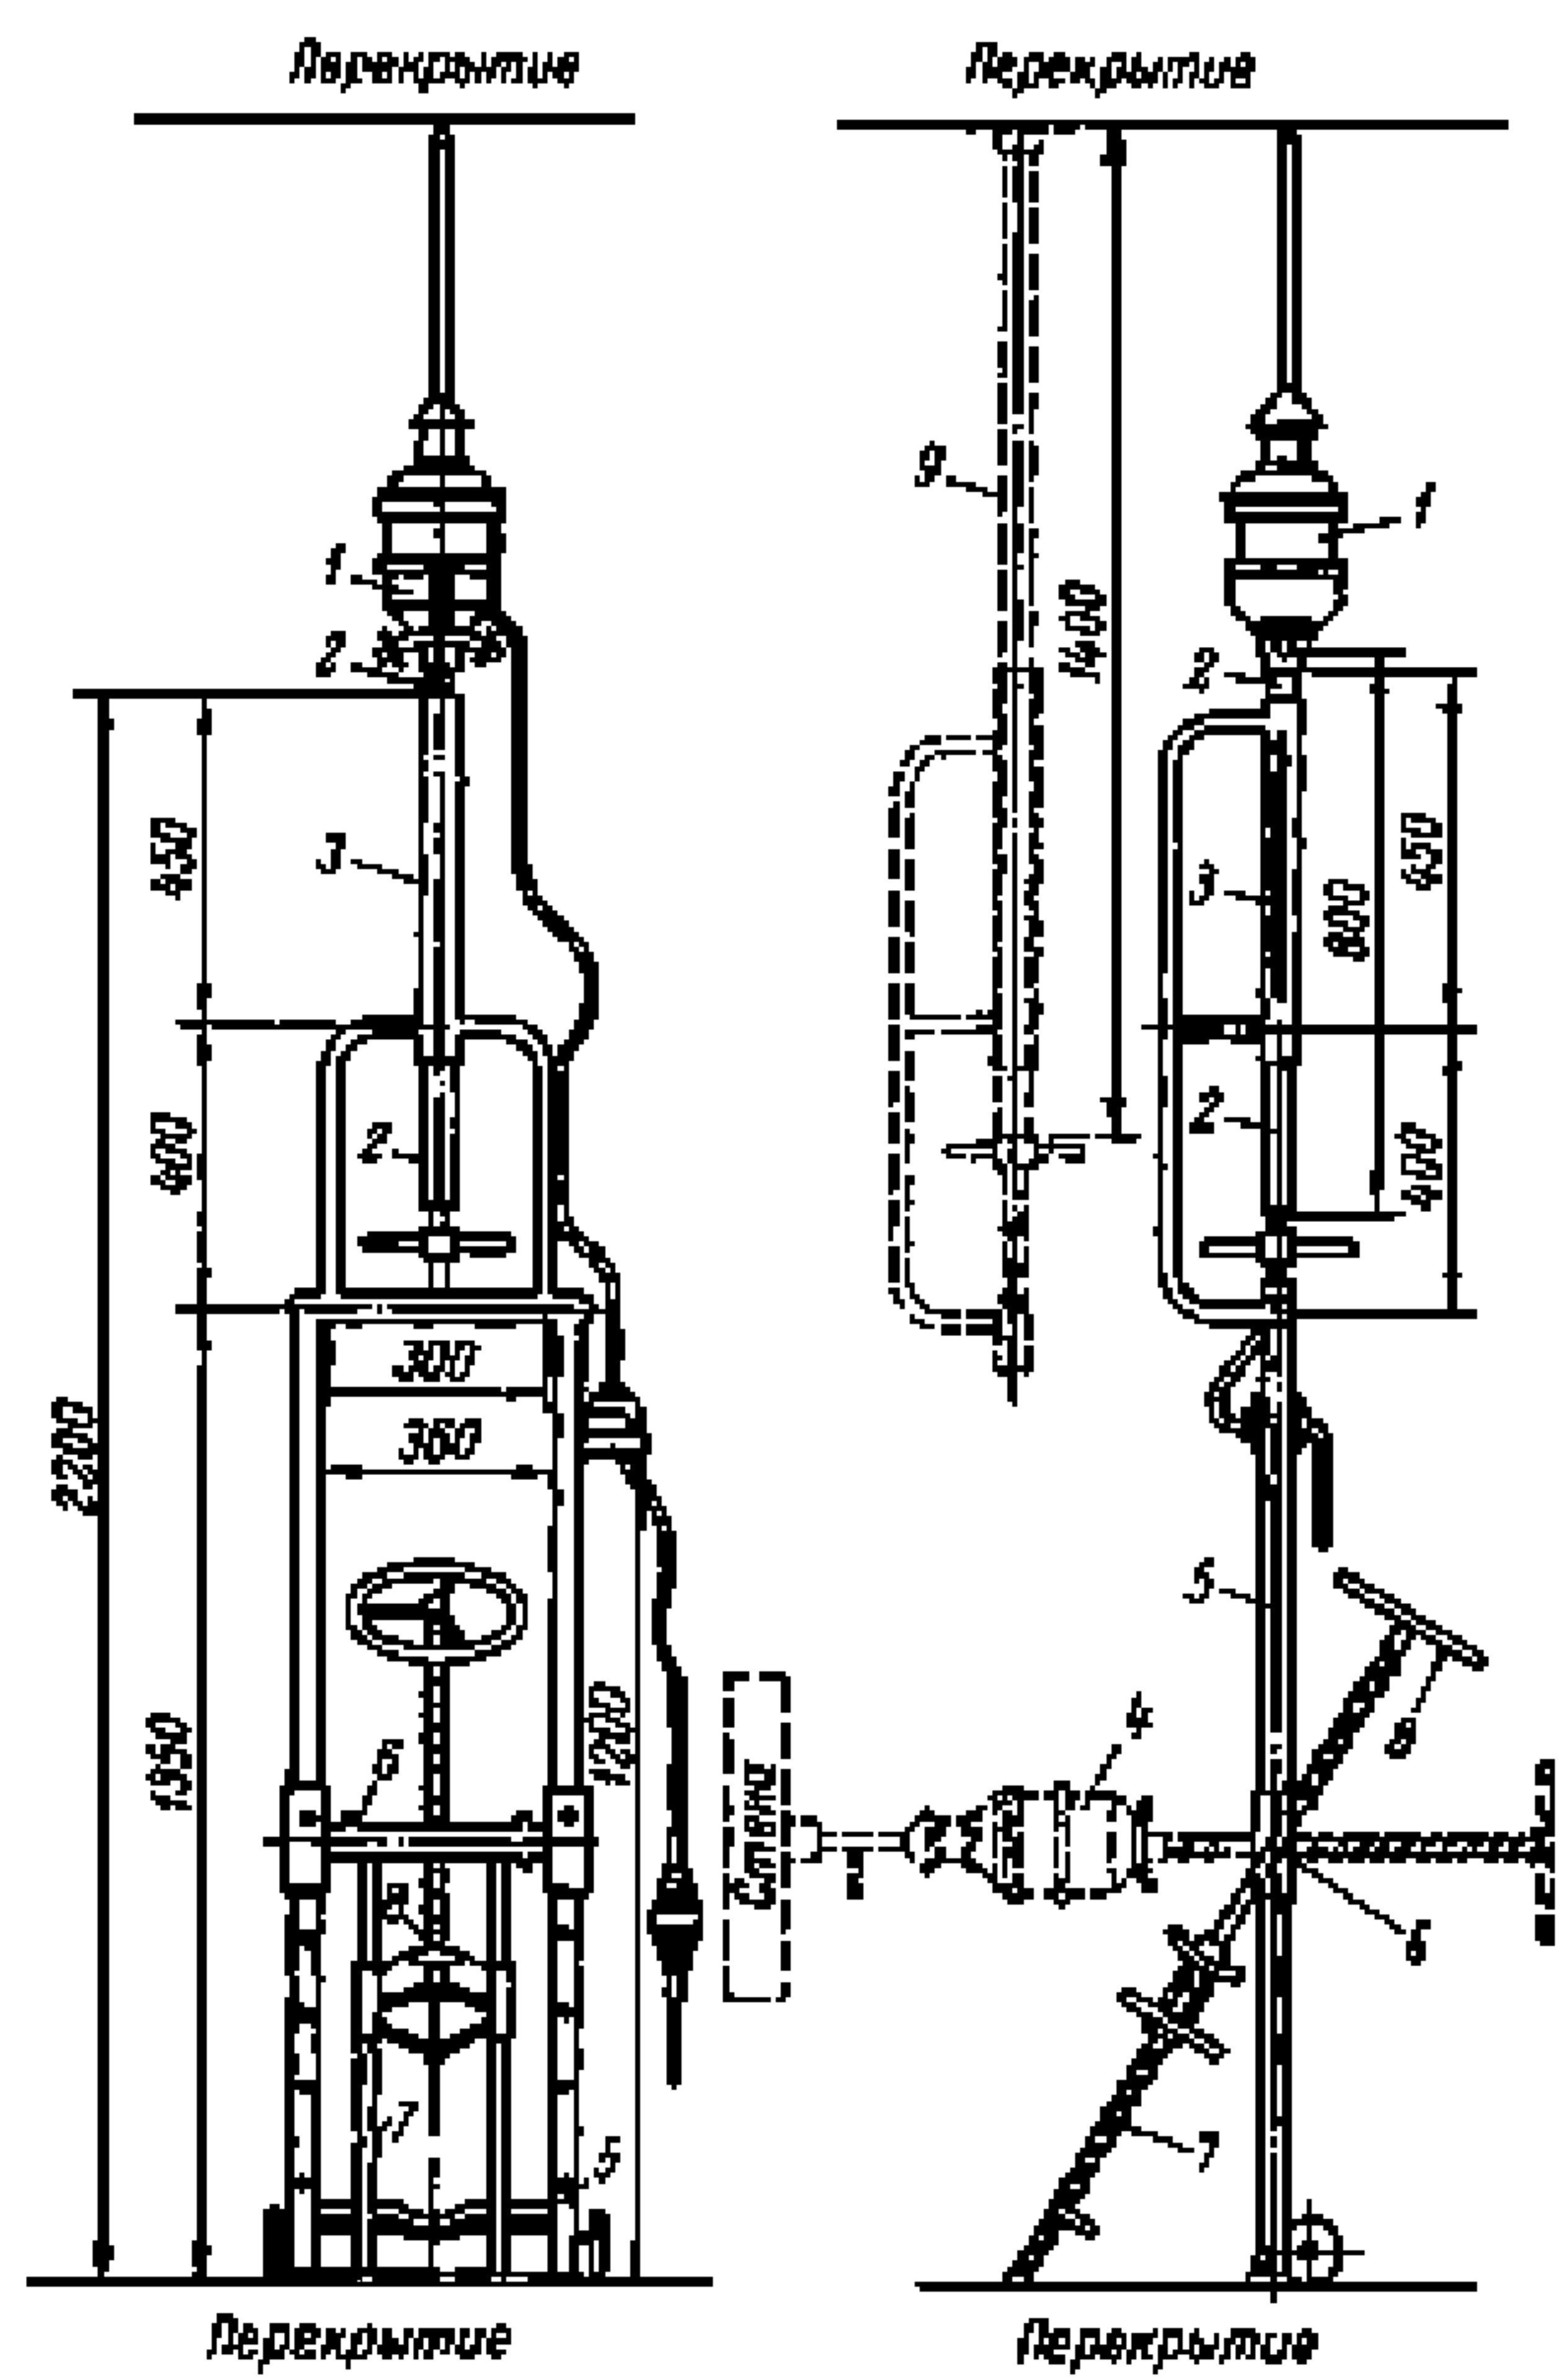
Станок-стойка для сверления отверстий в полах, потолках и стенах
